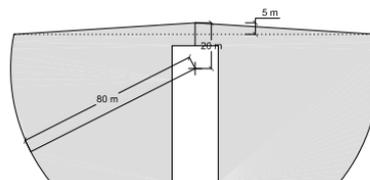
Volumen protegido por pararrayos con dispositivo de cebado
